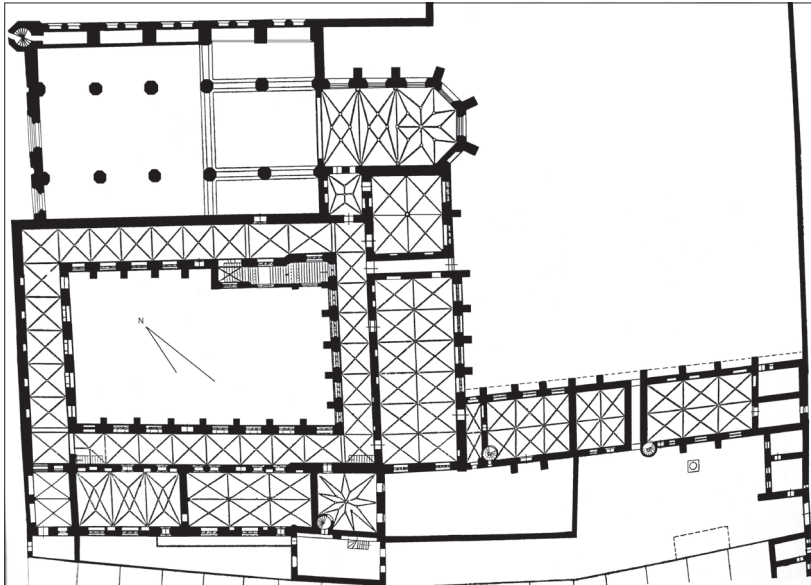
Lübeck St. Annen, Grundriss
